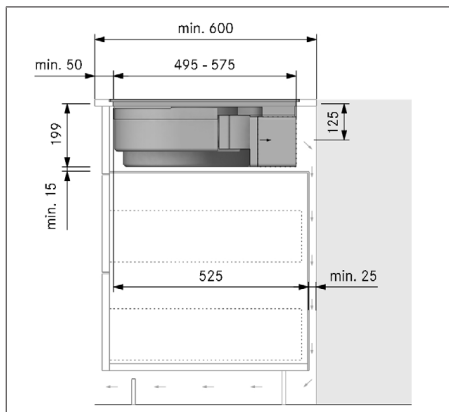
Cotes de montage pour le recyclage d'air, variante B, profondeur du plan de travail 600 mm
